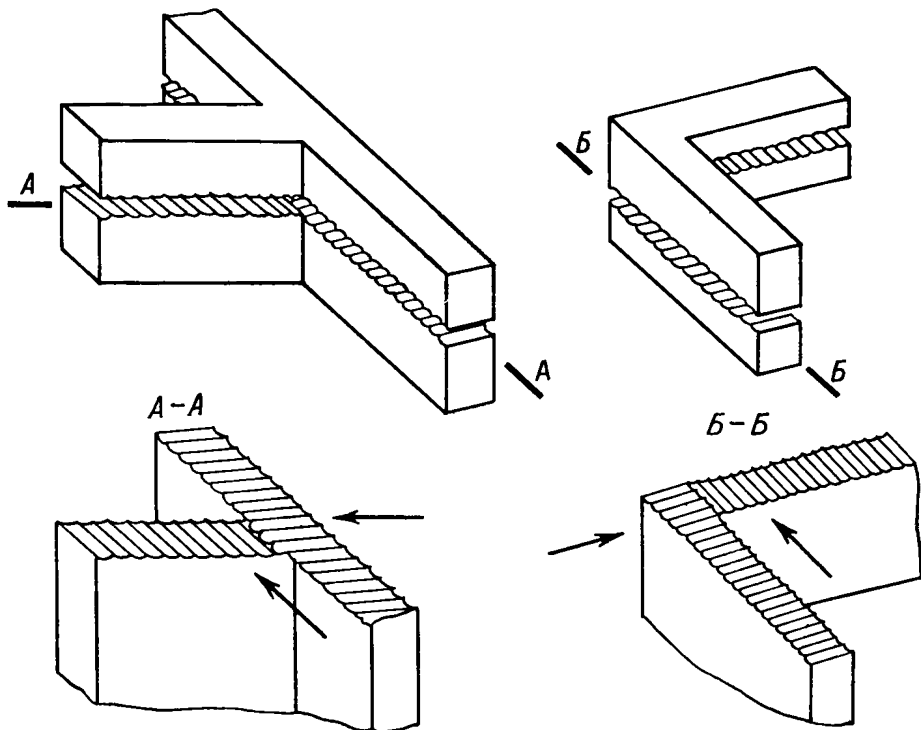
Схемы пропила Т- и Г-образных пересечений стен с помощью стенорезной установки
